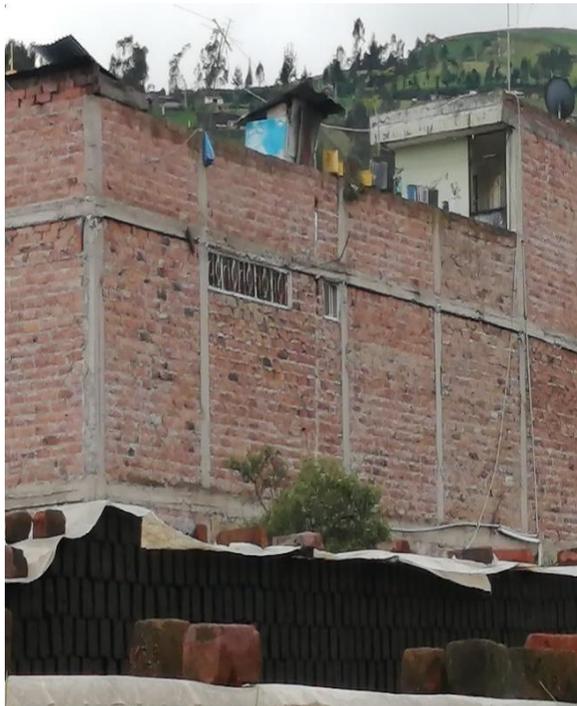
Tuberías Embebidas en la zona de confinamiento de la viga.
